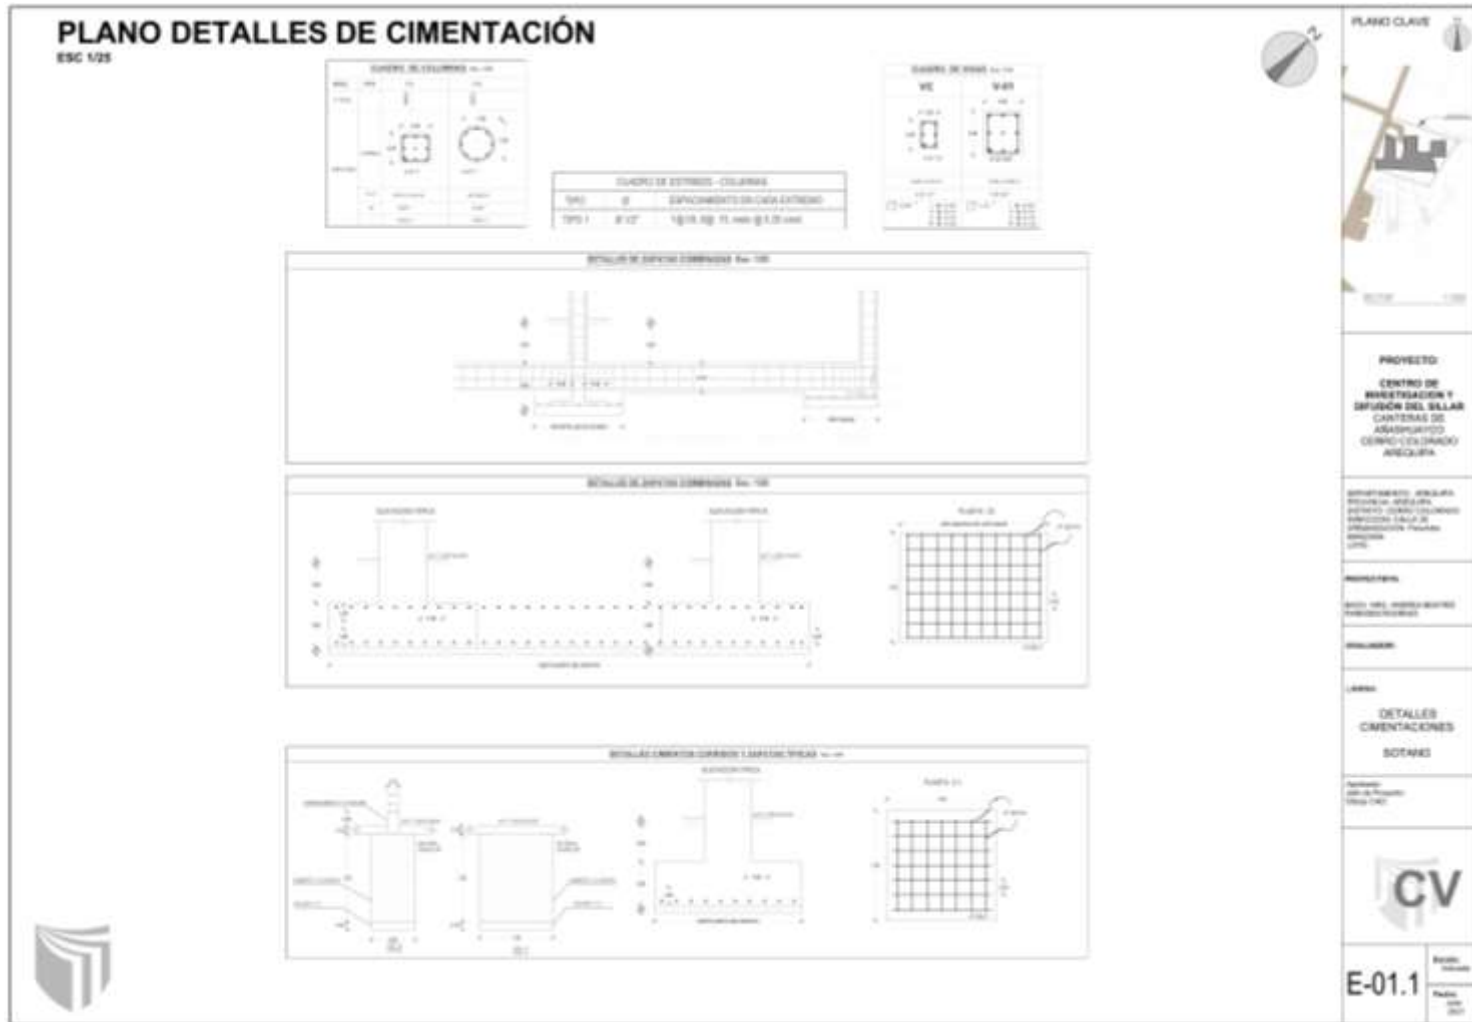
Plano de Cimentación – Sector – Área Académica E-01.1
